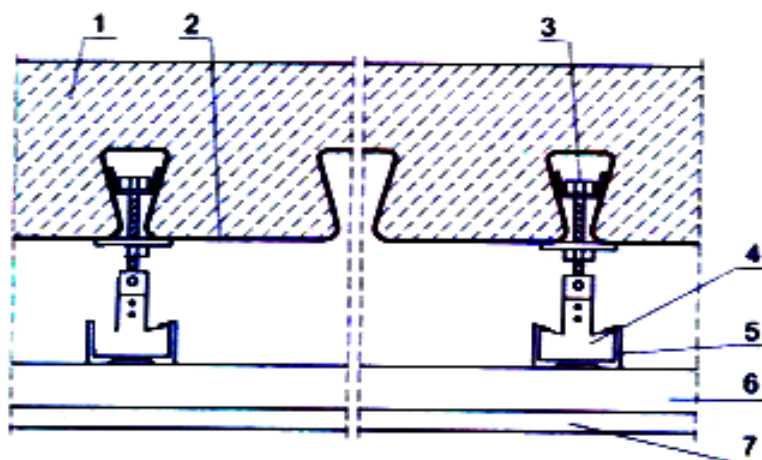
Модернизация деревянного перекрытия с применением монолитной железобетонной плиты с профилированным настилом [9]
